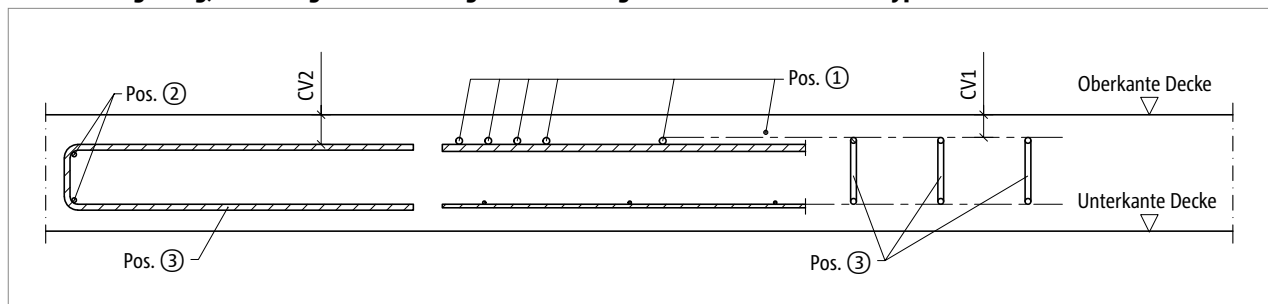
Schöck Isokorb® XT Typ CL: Bauseitige Bewehrung Außenecke (Schnitt XT Typ CL-L-CV2, Ansicht XT Typ CL-R-CV1)
